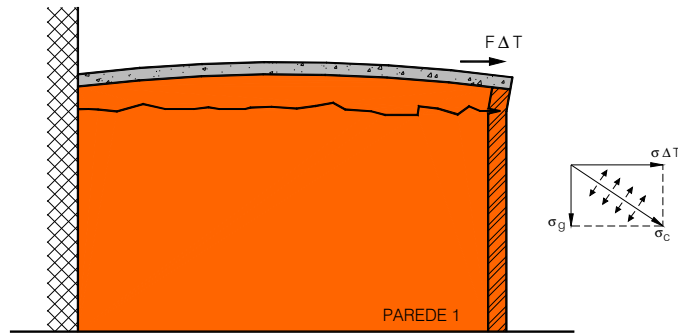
Fissura típica presente no topo da parede paralela ao comprimento da laje [30]
